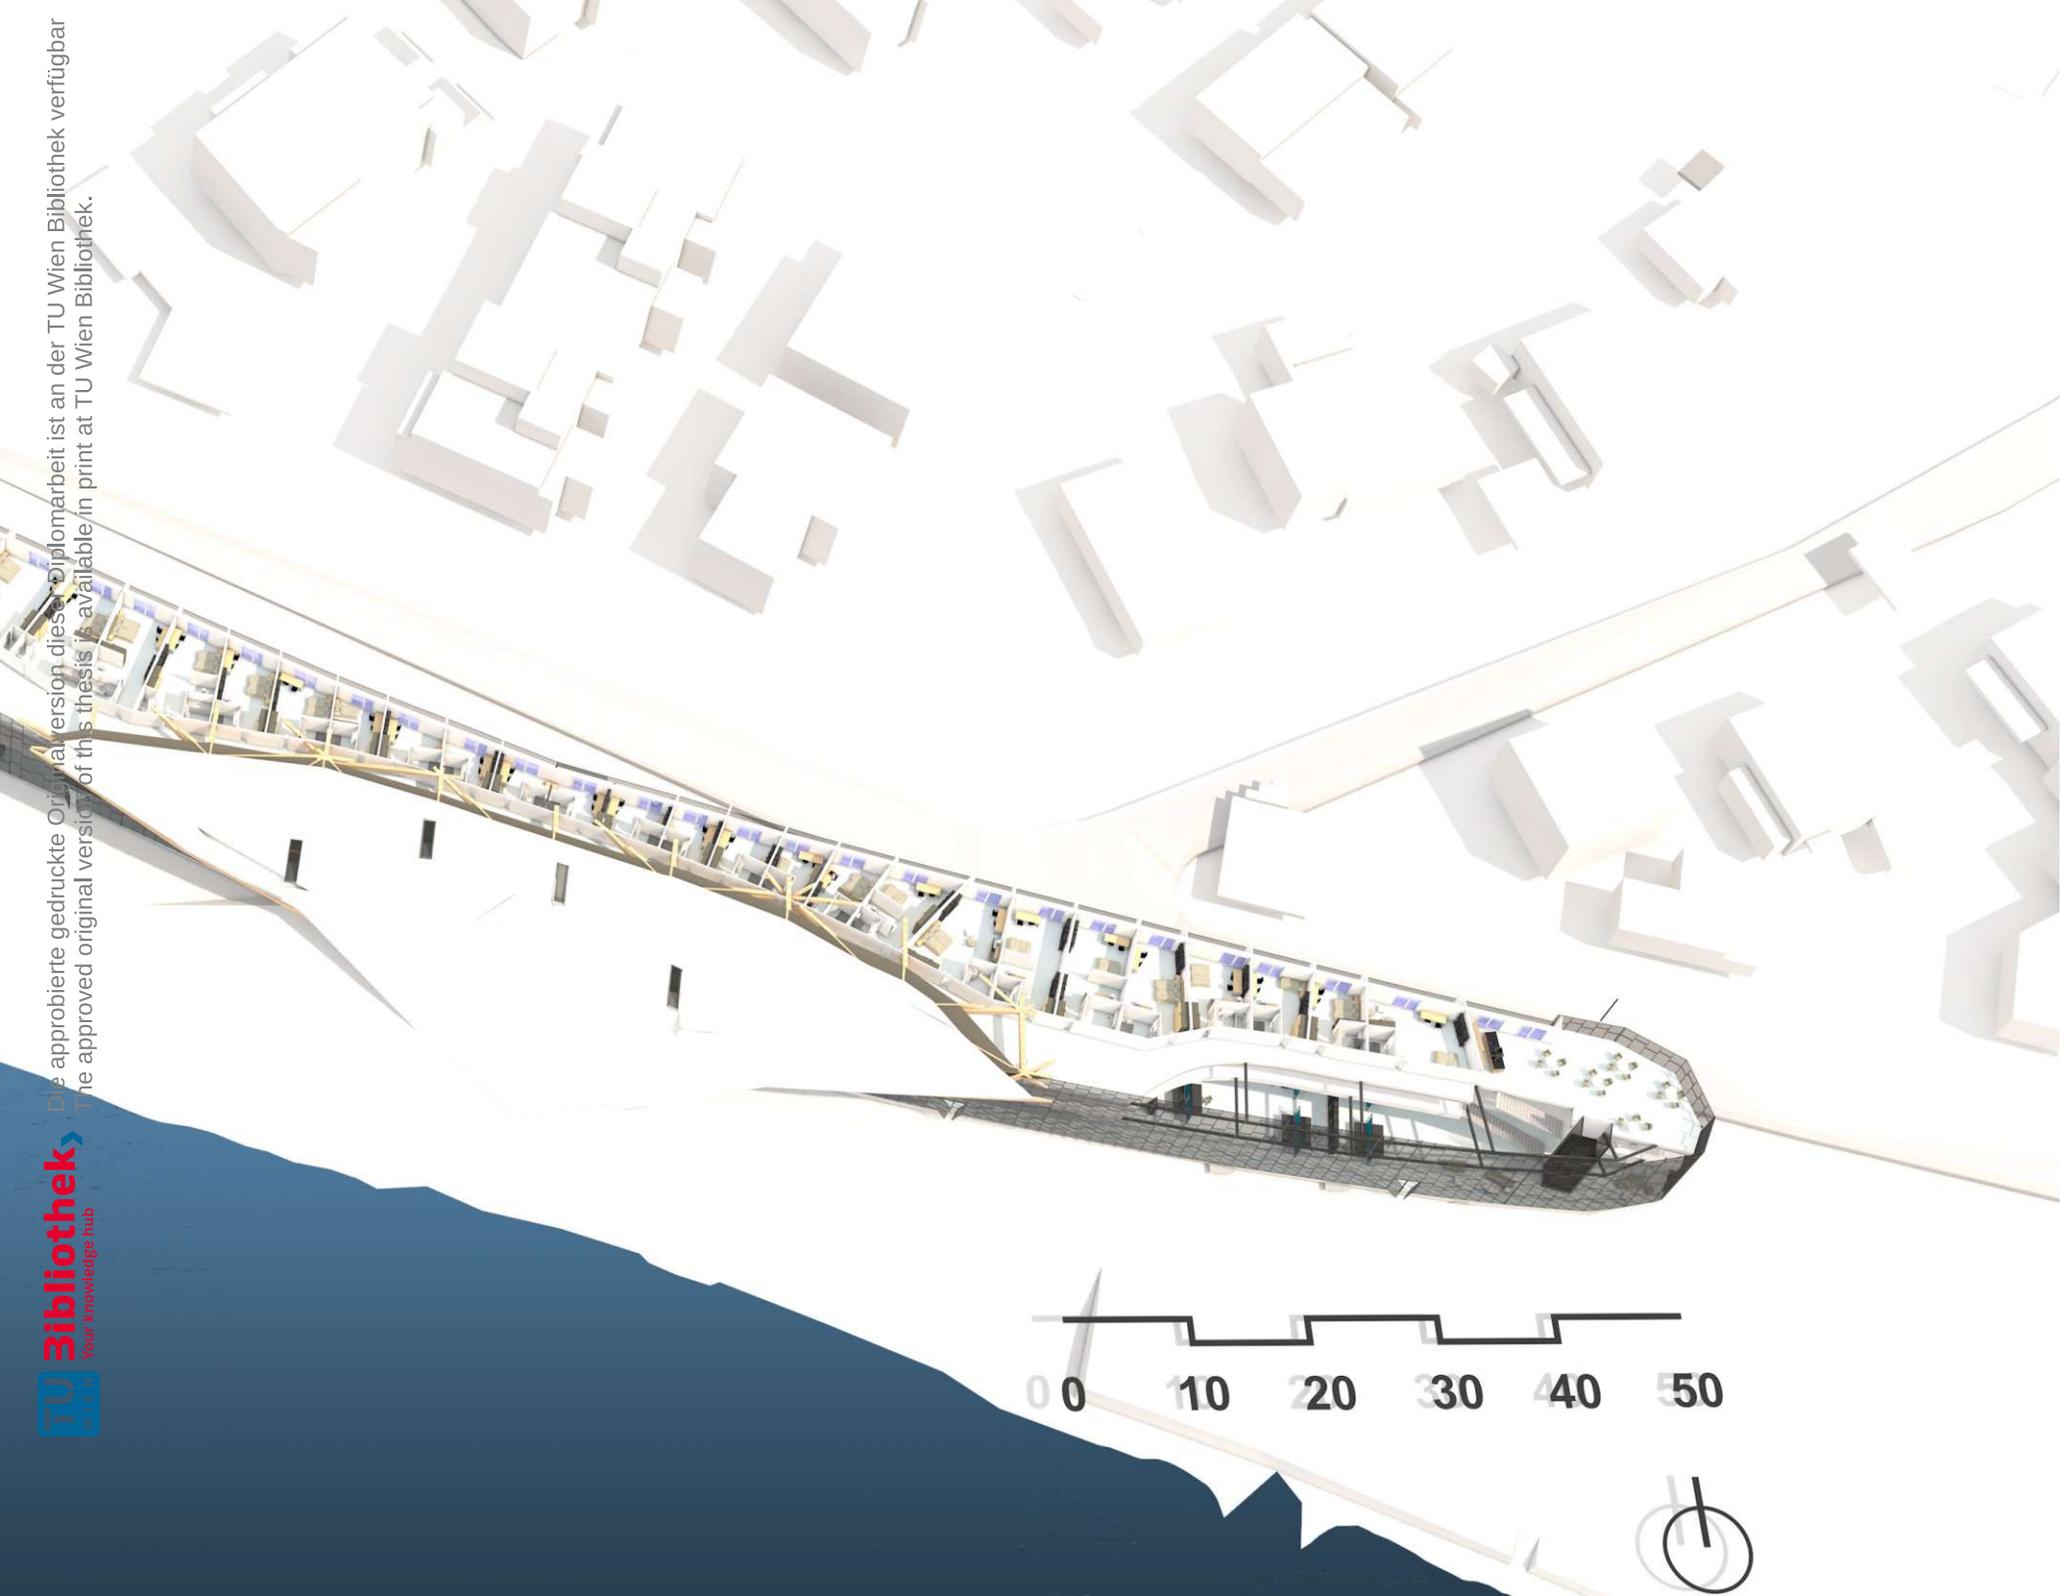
3D Grundriss 2. Obergeschoss
